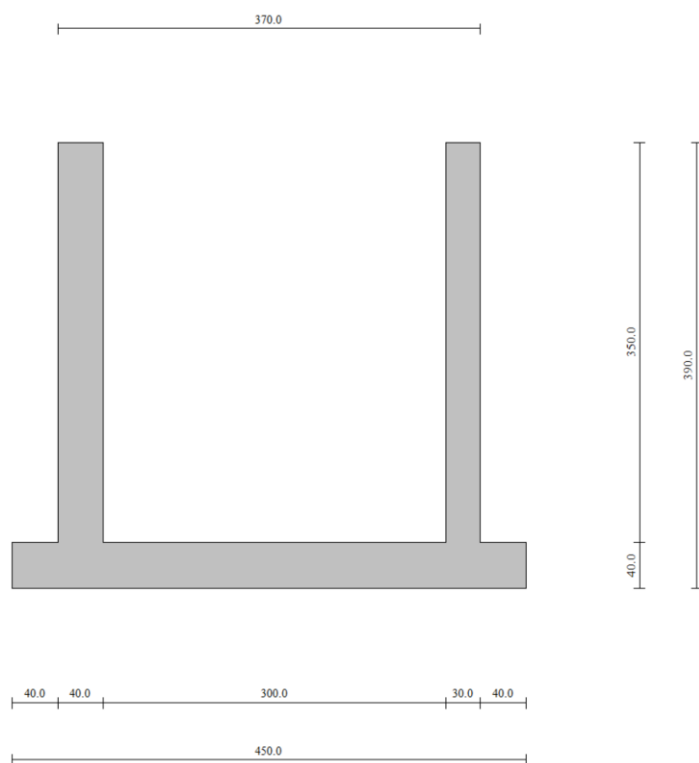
SEZIONE CANALE IN PROGETTO
